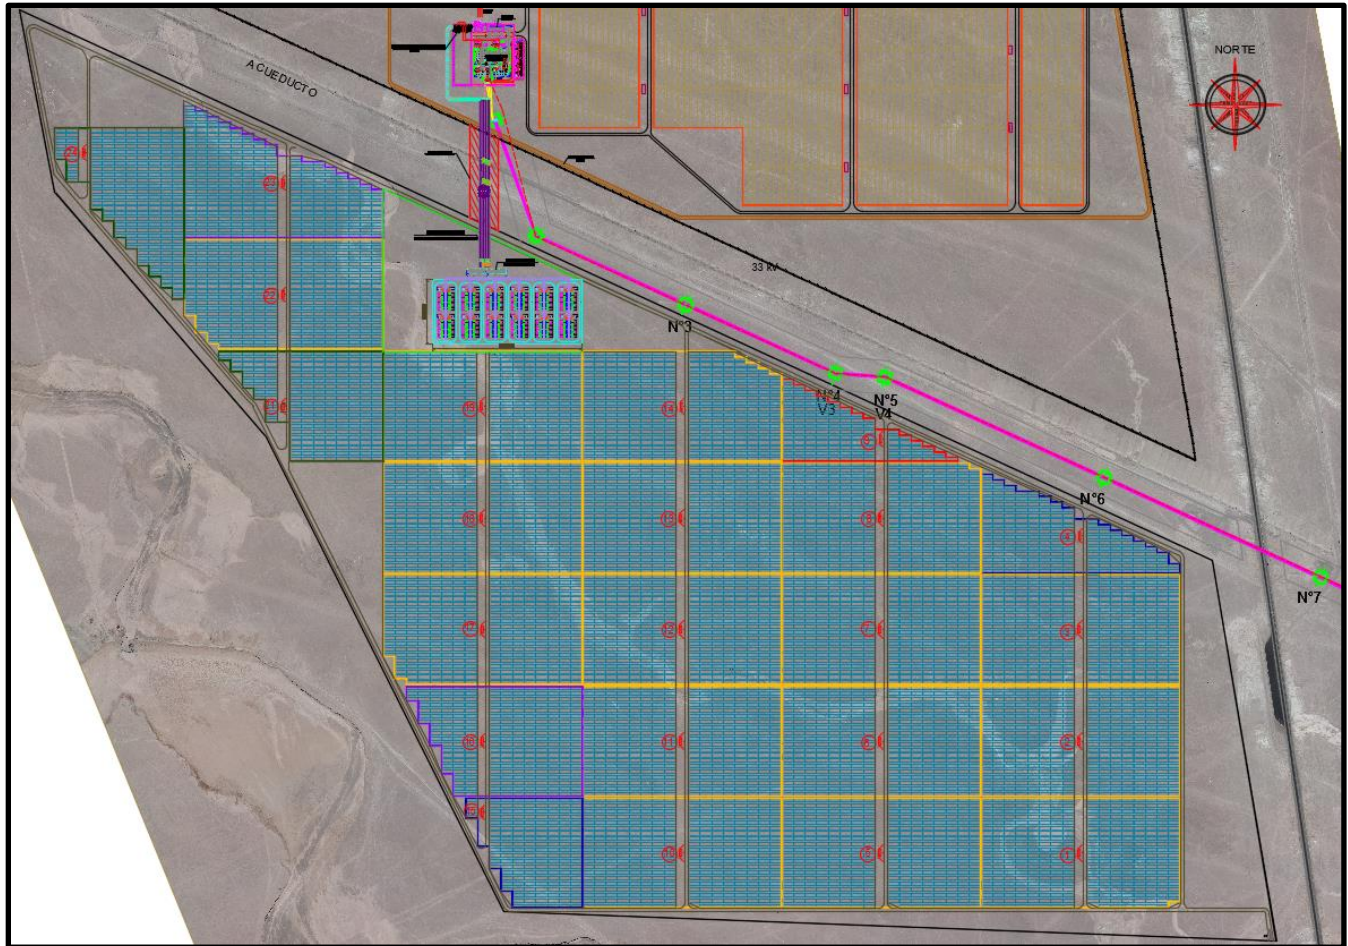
Emplazamiento del Proyecto CRCA La Pampina
